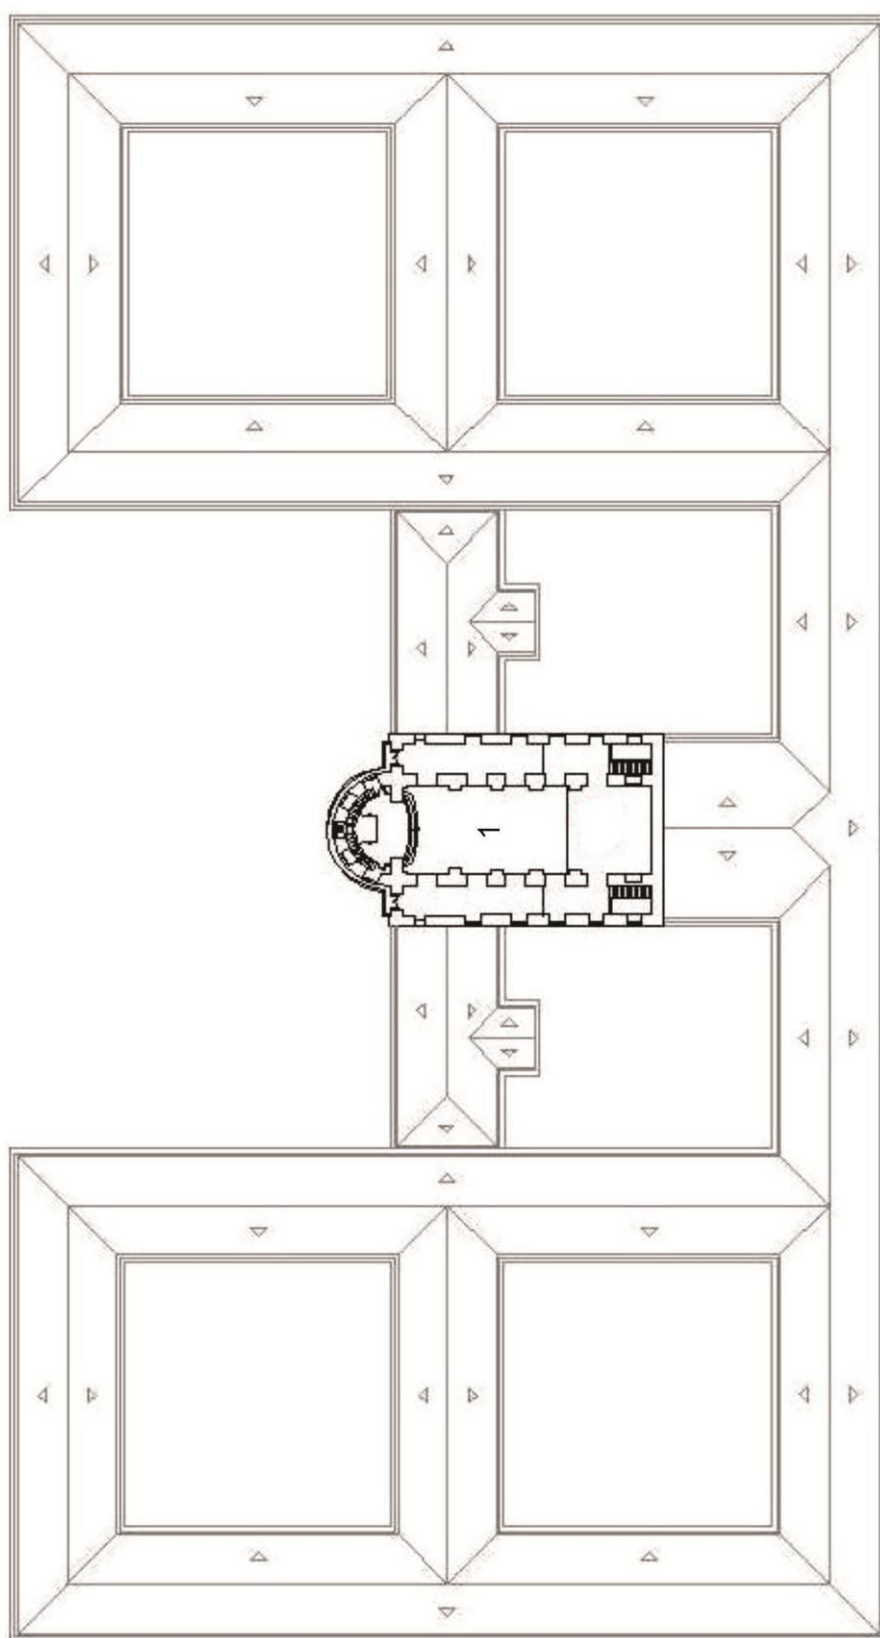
Planta do Segundo Pavimento. Fonte: Hoirisch, 2007. Esquema da Autora.
